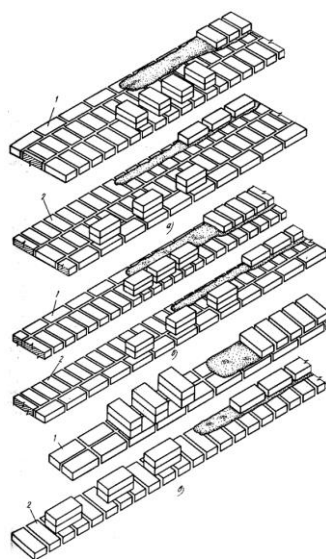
Раскладка кирпича при кладке стен толщиной:
